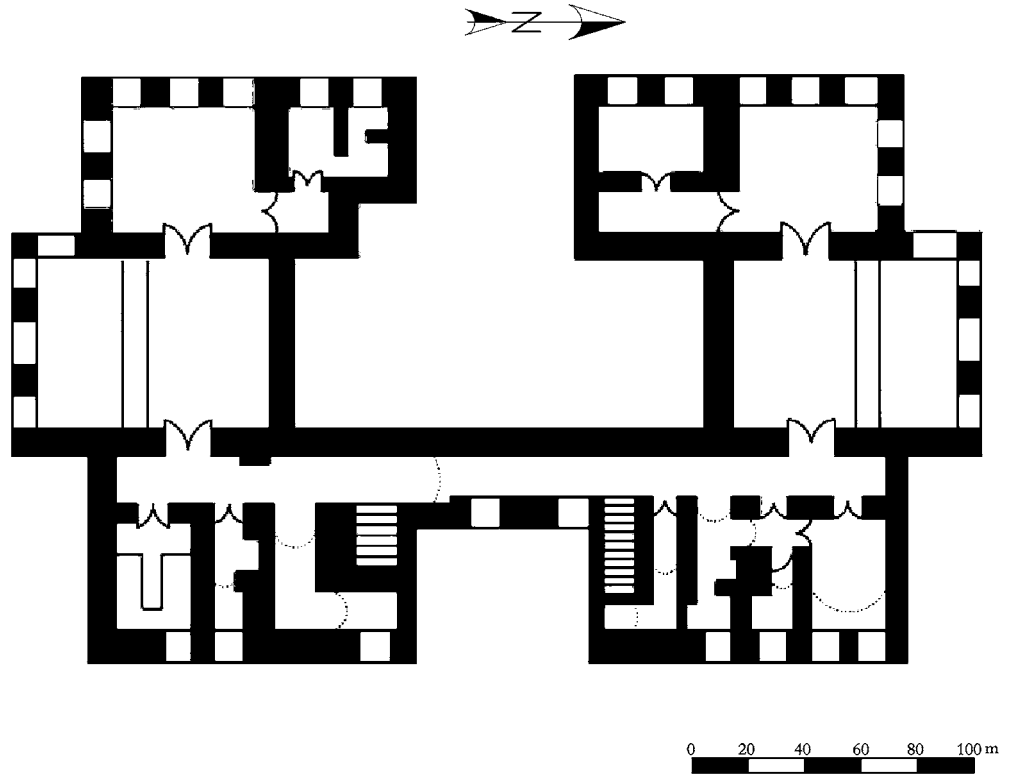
بيت الكعكي: مسقط أفقي للطابق الأول ويلاحظ توزيع ومواقع وحدات الحمامين. (عمل بمعرفة الباحث).
